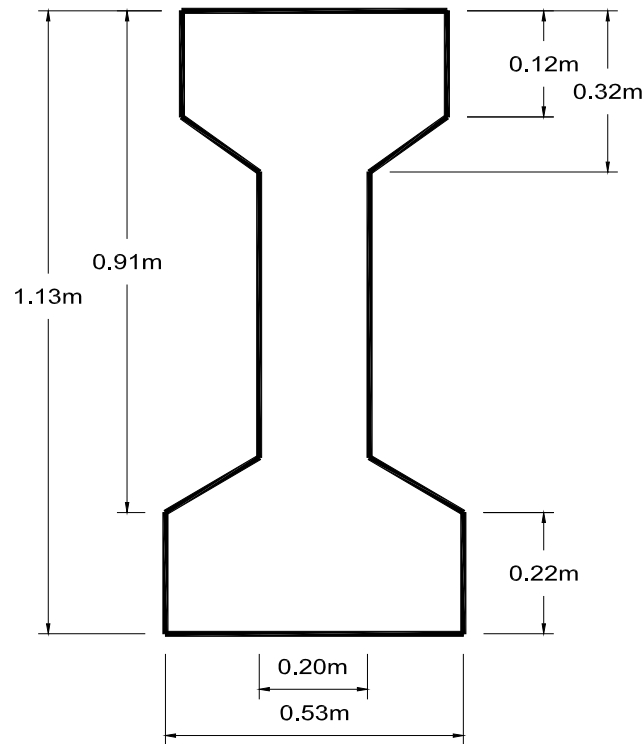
Dimensiones de las vigas I en el puente Maravatío km 206
